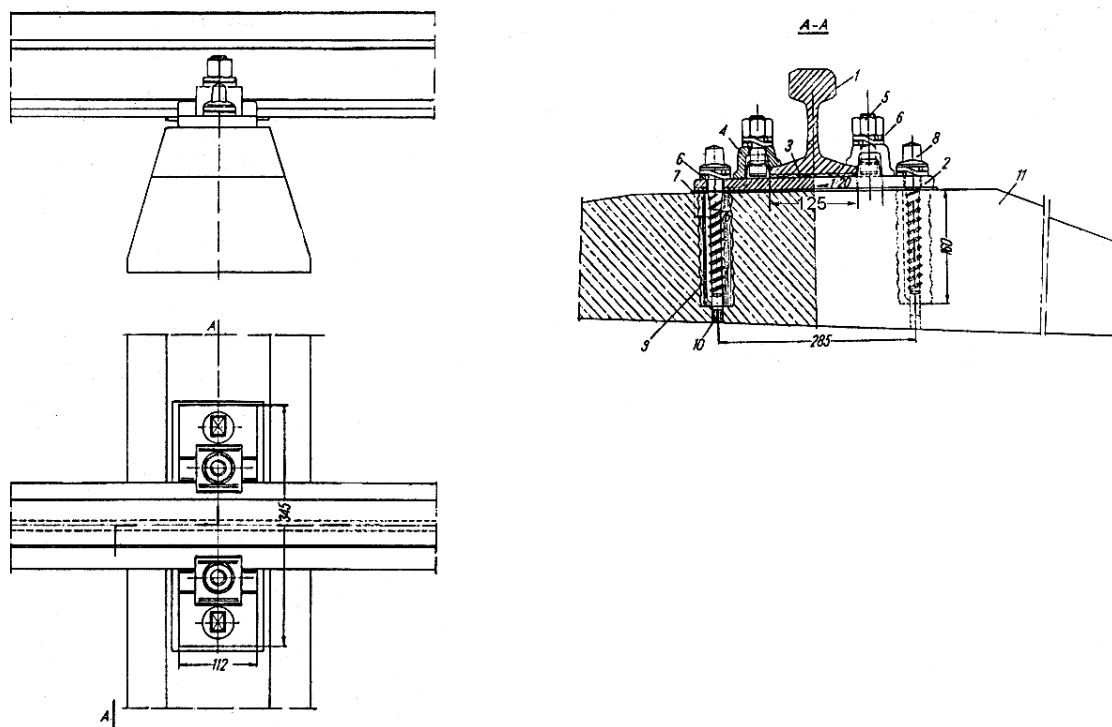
Przytwierdzenie typu SB szyny UIC60(60E1) do podkładów betonowych
